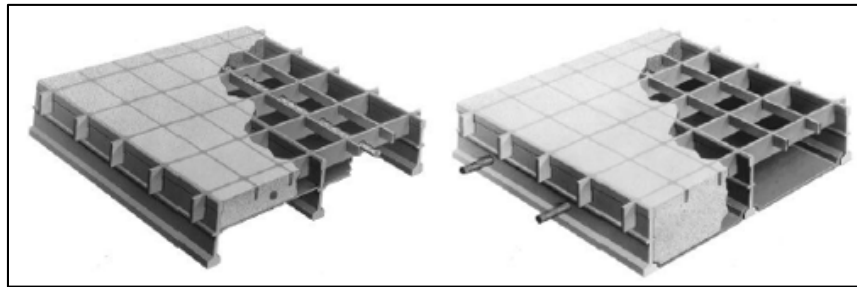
Esquema de una cubierta de parilla de acero rellena con concreto. (Chen y Duan, 2003).
